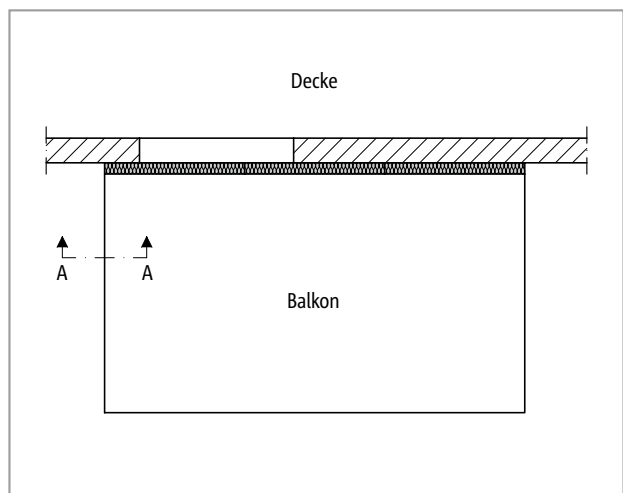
Schöck Isokorb® T Typ K: Darstellung der Lage von dem Schnitt A-A
